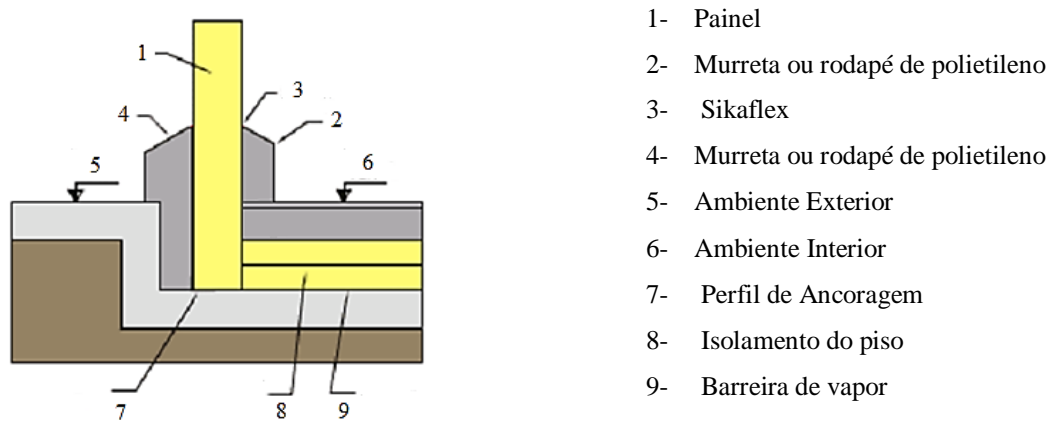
Montagem dos painéis verticais sobre o pavimento e execução do pavimento da câmara frigorífica (Vilain, 2006)
